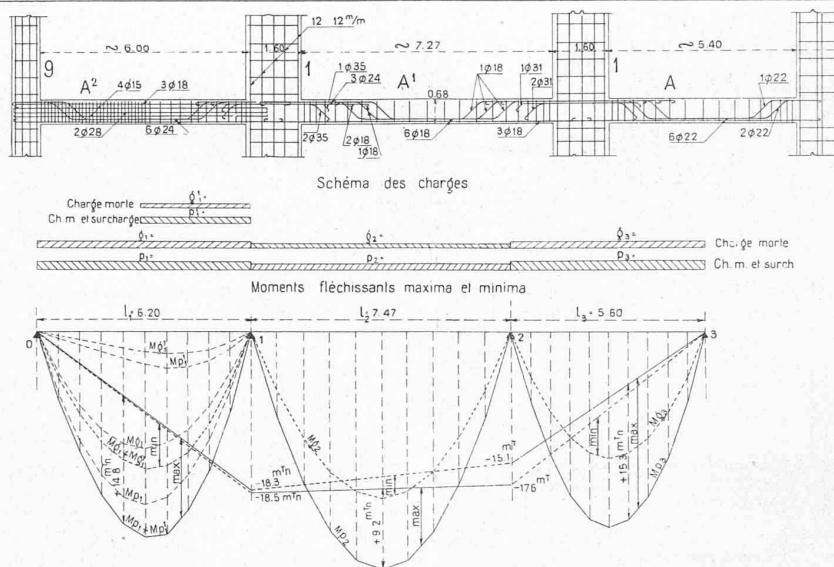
Poutraison du rez-de-chaussée. Détail des armatures. — Surcharge : 350 kg.
